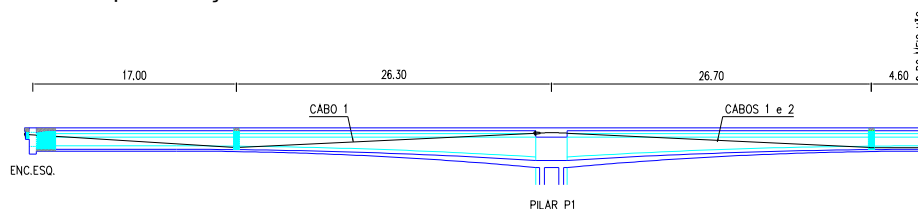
Traçado dos cabos de pré-esforço exterior em perfil longitudinal
